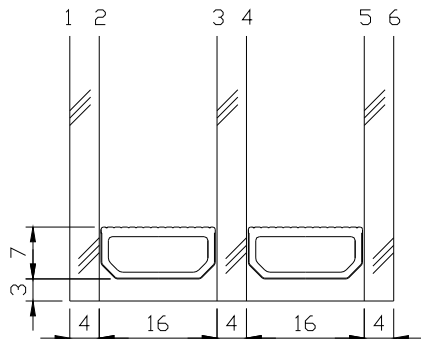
Mehrscheiben-Isolierglas mit Abstandhalter Thermix TX.N in einem 3-fach-Isolierglas
